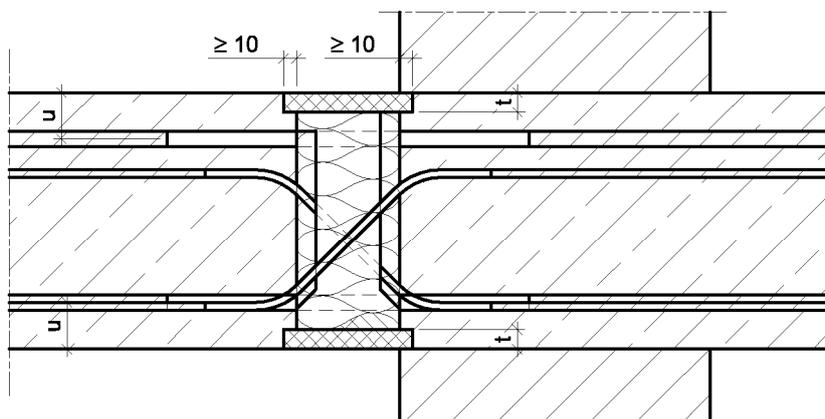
Schöck Isokorb Typ D (F30/F90)
